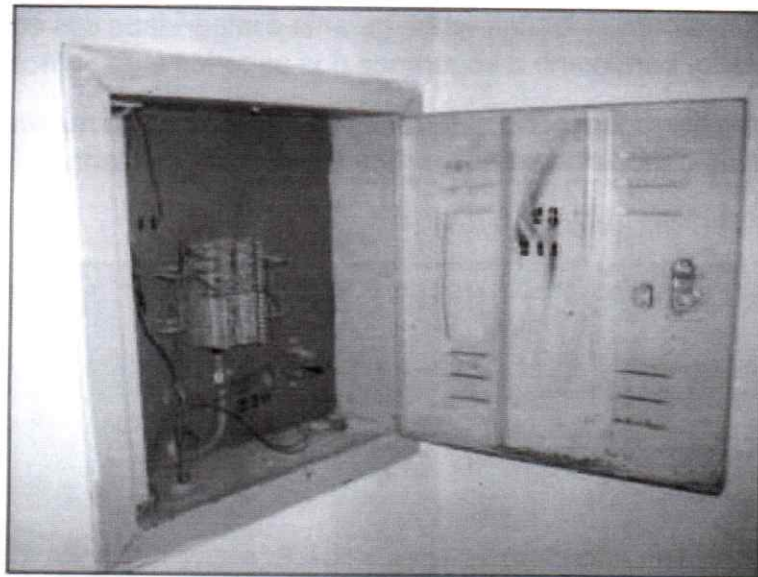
Caixa de distribuição de telefonia - 1º pavimento.
